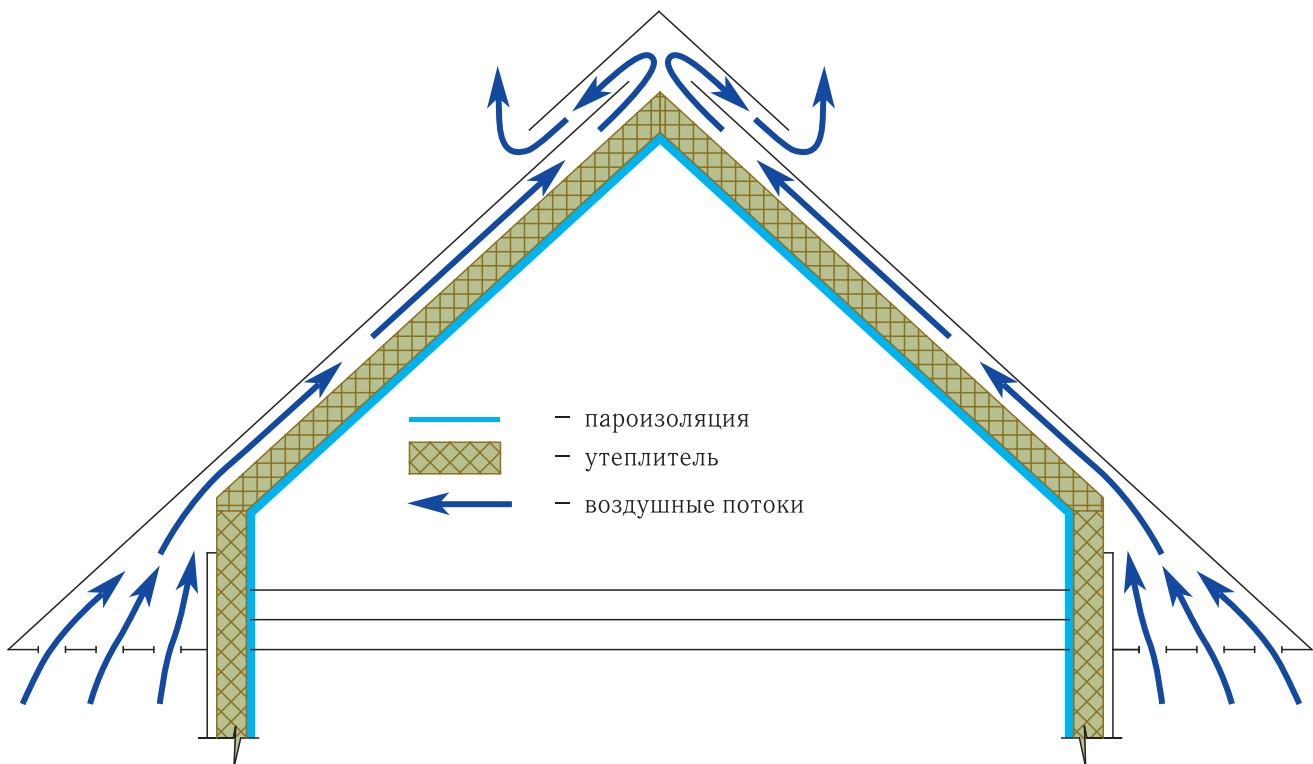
Схема утепления, пароизоляции и вентиляции «жилой мансарды»
